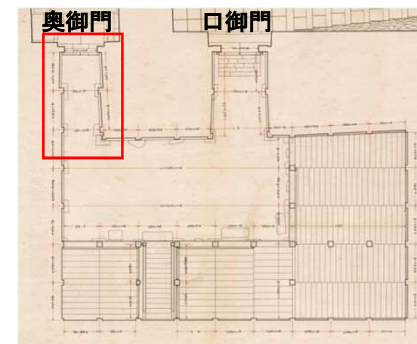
昭和実測図「小天守地階平面図」(部分)
